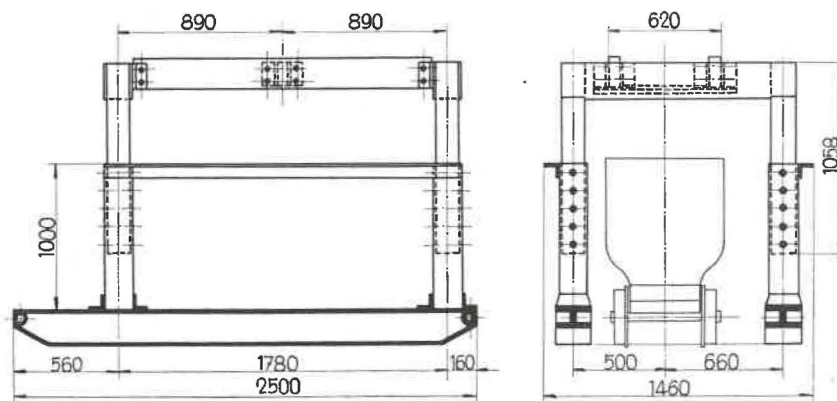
Plan de l'estacade de chargement pour wagonnets de 570 litres.
